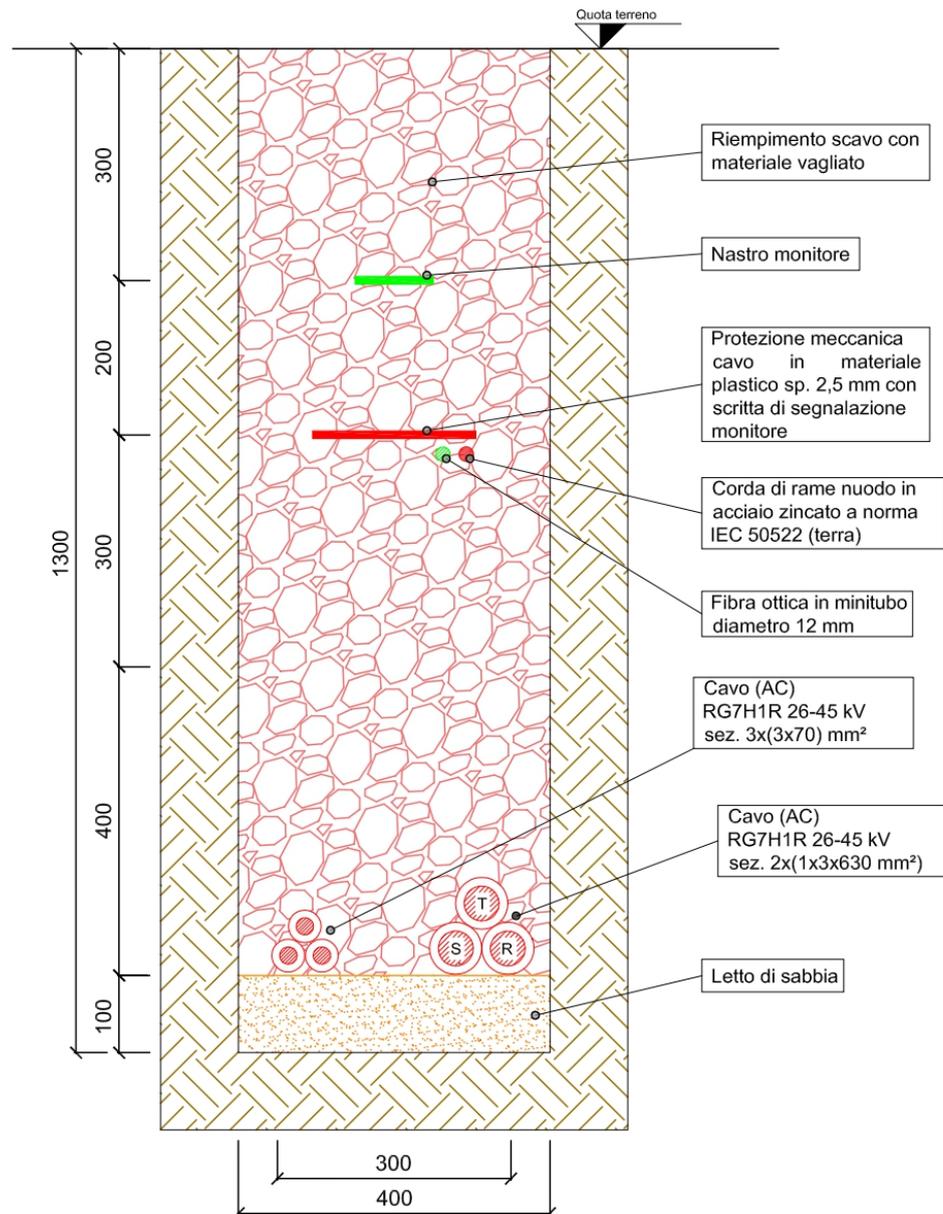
Tipico sezione di posa con un cavidotto interno da 3x630 e uno da 3x70 mm²
